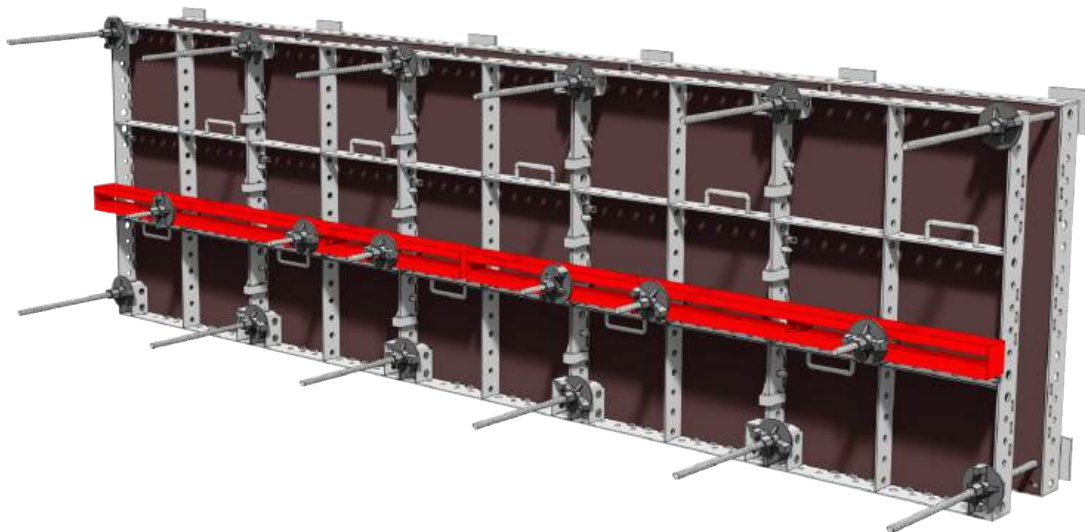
Alinhamento painel Tekko® SH com perfis C e parafuso L reforçado.
